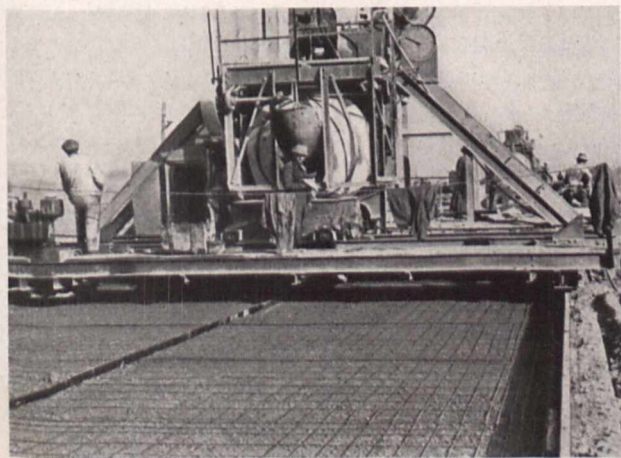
Für den Betonstraßenbau verwendet man heute Baustahlgewebe-Matten, bei denen die Längsbewehrung auf Kosten der Querbewehrung verstärkt wurde. Daraus ergibt sich die deutlich erkennbare Form der Matten
